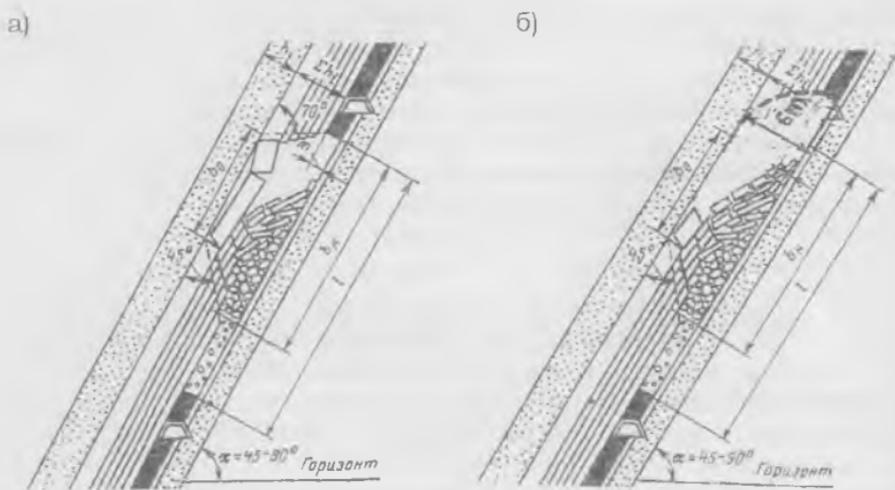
Схема разрушения пород основной и непосредственной кровли при разработке крутых пластов:
